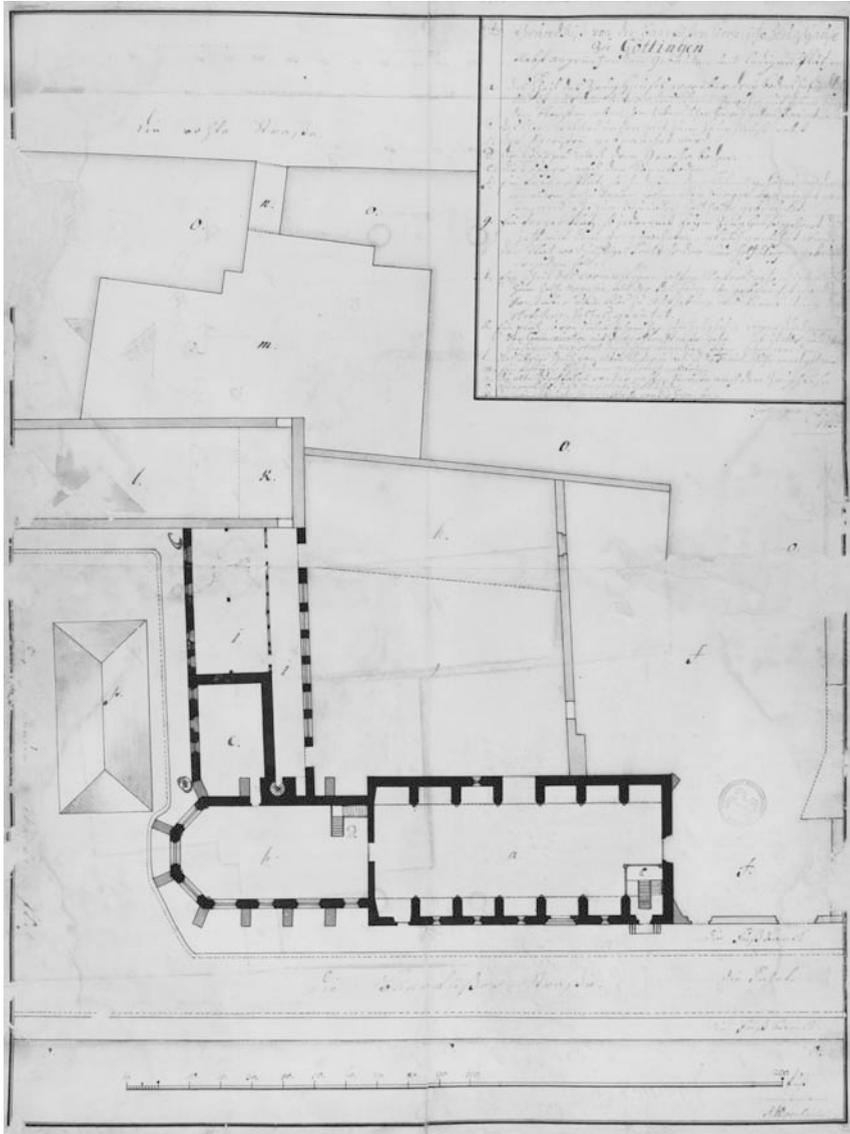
A. Overheide: Grundriss des ehemaligen Barfüßerklosters im Jahr 1735
